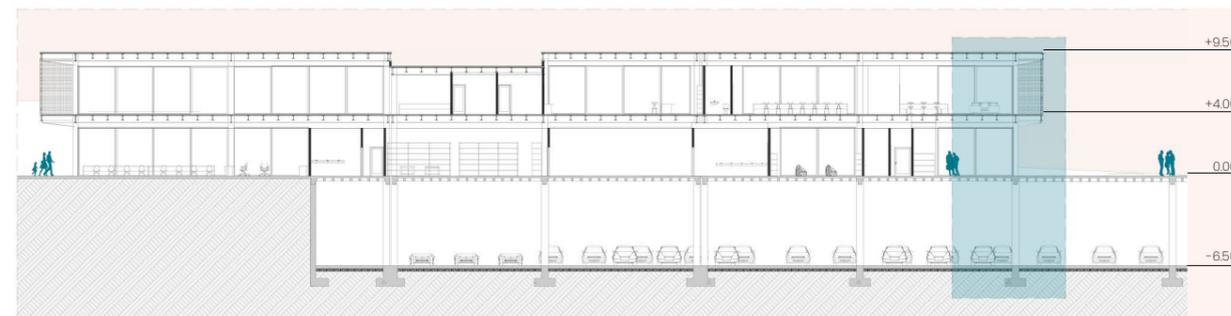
Sección constructiva bloque central Fuente: Propia, 2022
